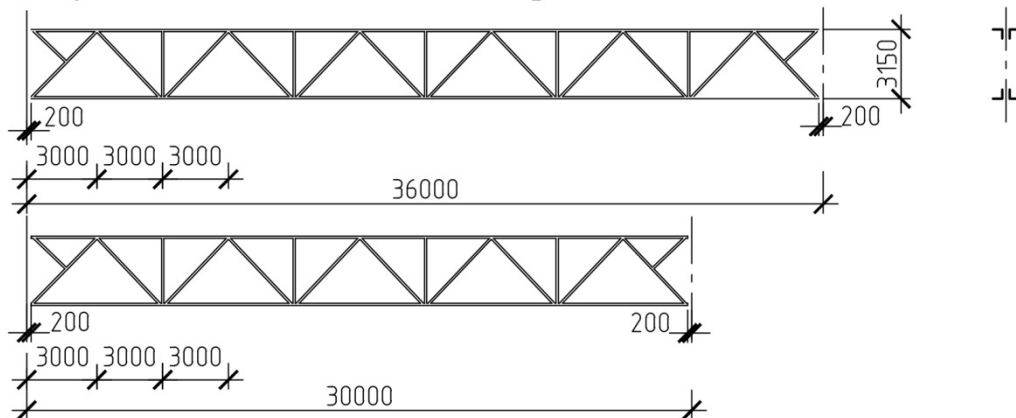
Схемы стальных стропильных ферм для стального и смешанного каркаса.
